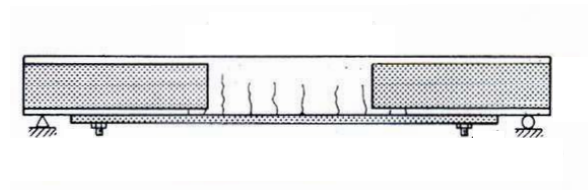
Renforcement complémentaire par des plaques collées sur les côtés de la poutre sur toute la zone d'existence d'effort tranchant
